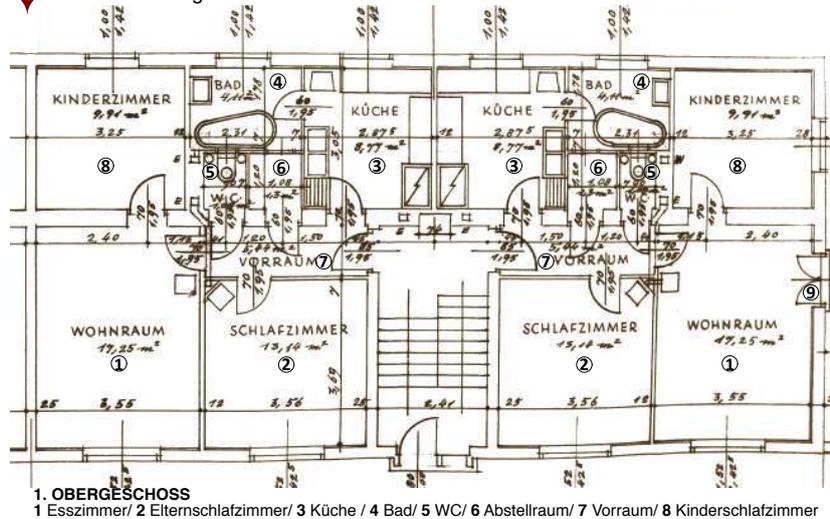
Grundrisstyp 1 von Eugen Wörle für Bauabschnitt 3
